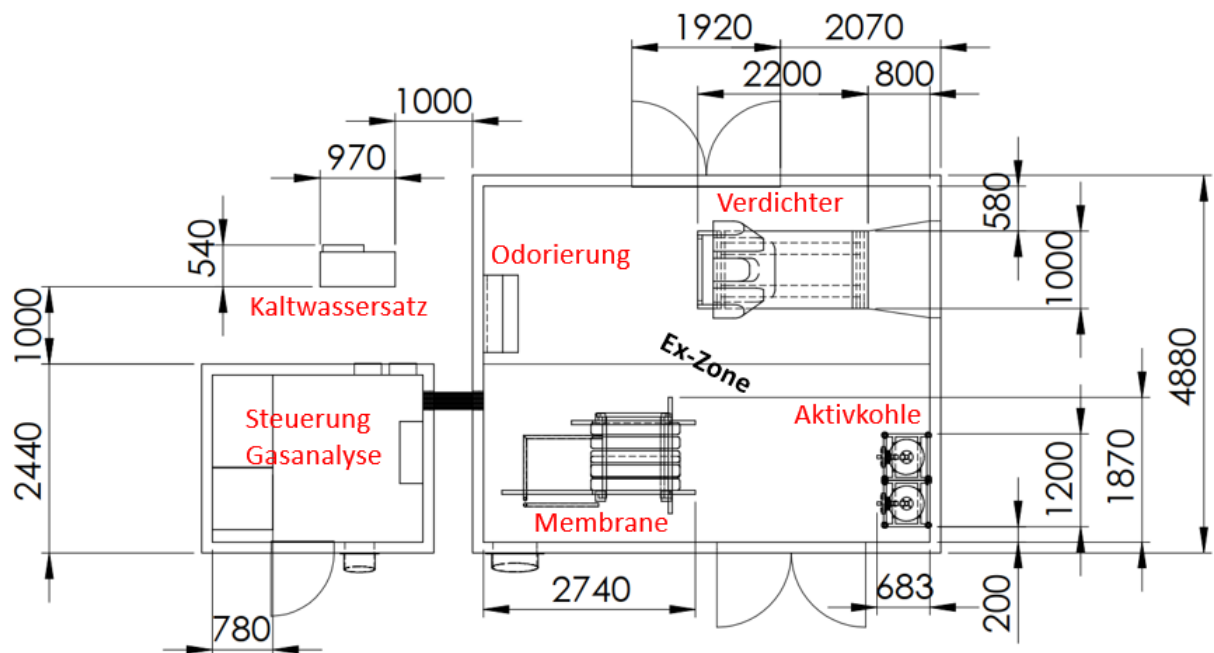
Grundriss der Aufbereitungsanlage mit den wichtigsten Anlagenkomponenten.
